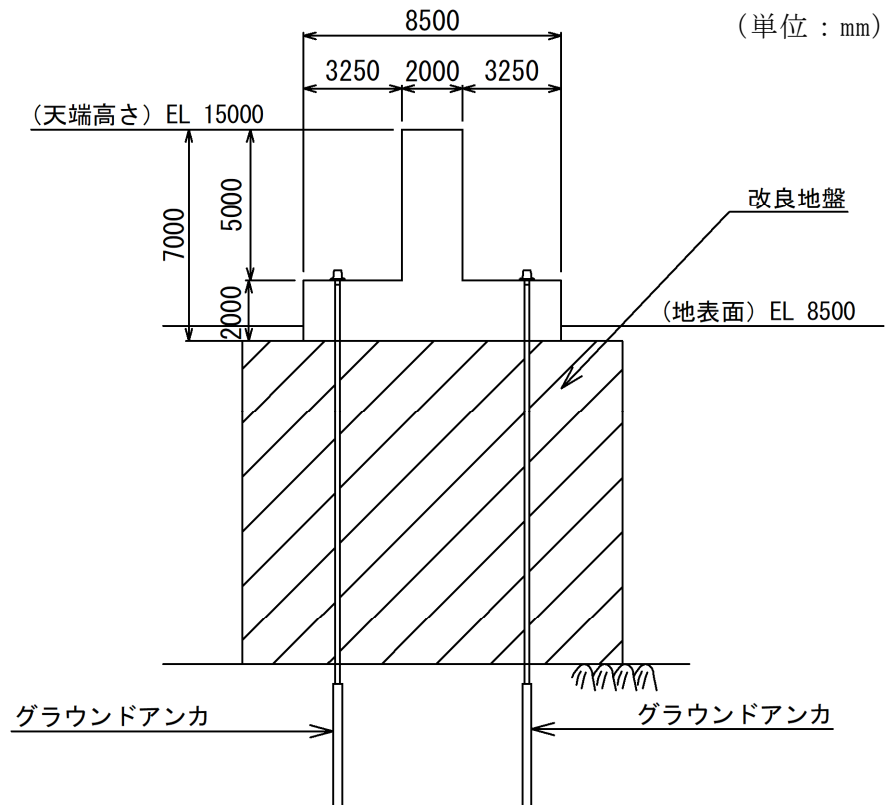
防波壁（逆 T 擁壁）の構造図（断面図）
